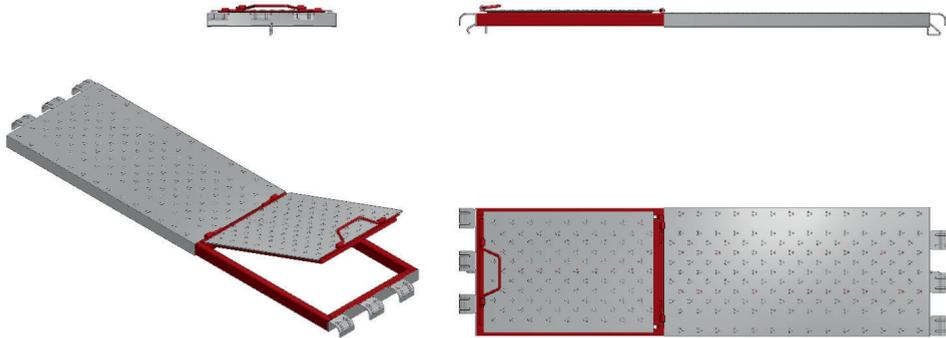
Apertura di accesso nell'impalcato (Fonte: Marcegaglia Buildtech)
